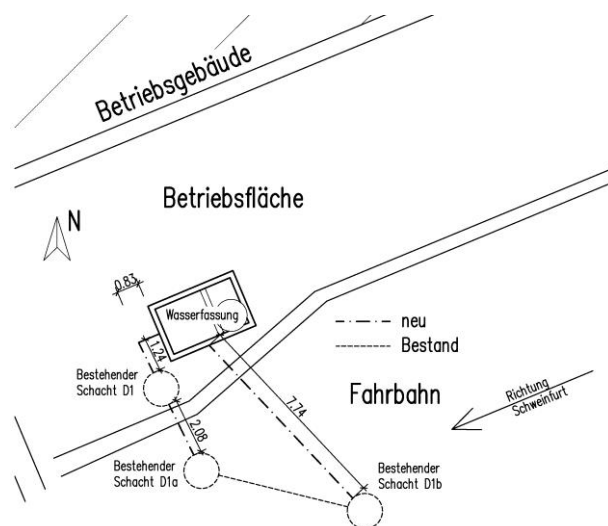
Wasserfassung Rennsteig; Skizze Lageplan
